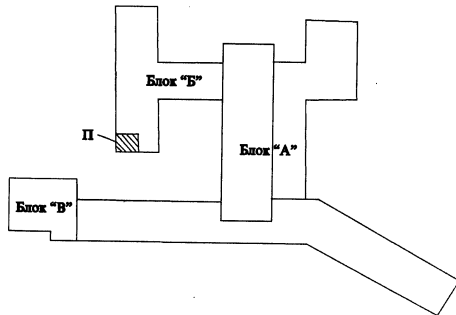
Схематичный план комплекса зданий больницы Штриховкой обозначено расположение помещения, пострадавшего от пожара (блок Б, 2-й этаж, комната №5)
